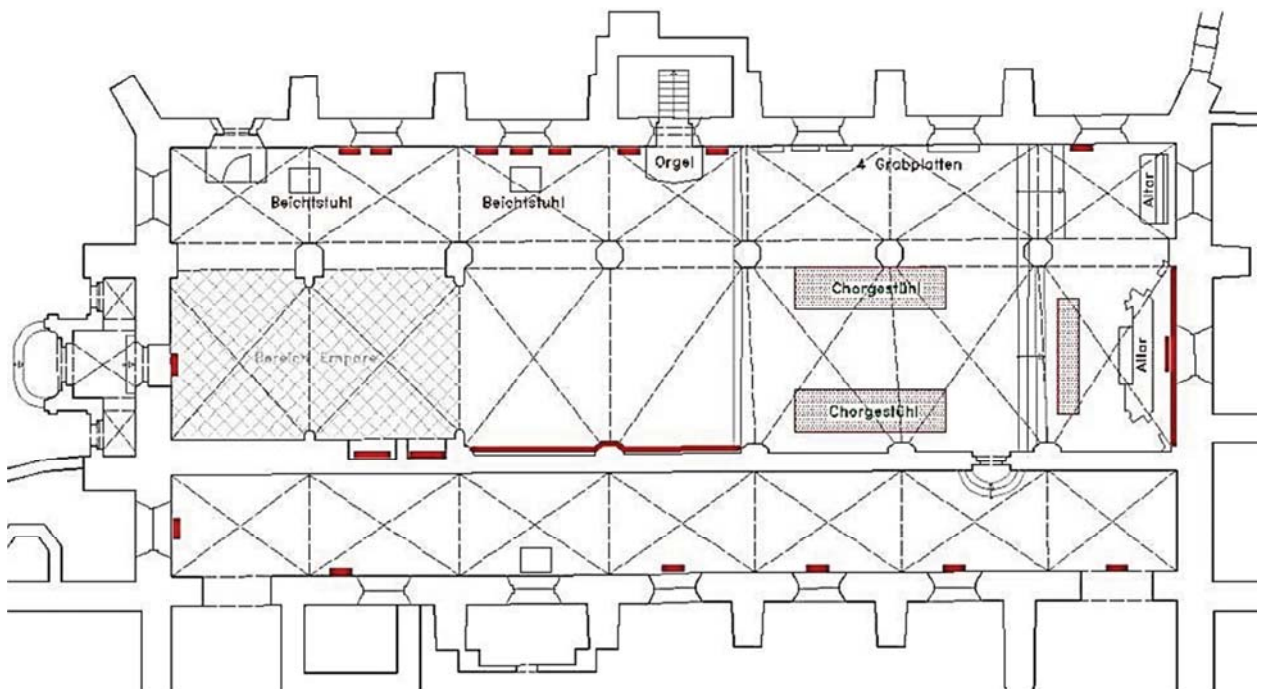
Grundriss Klosterkirche mit ehemaligen Heizungssystem bis 2008
